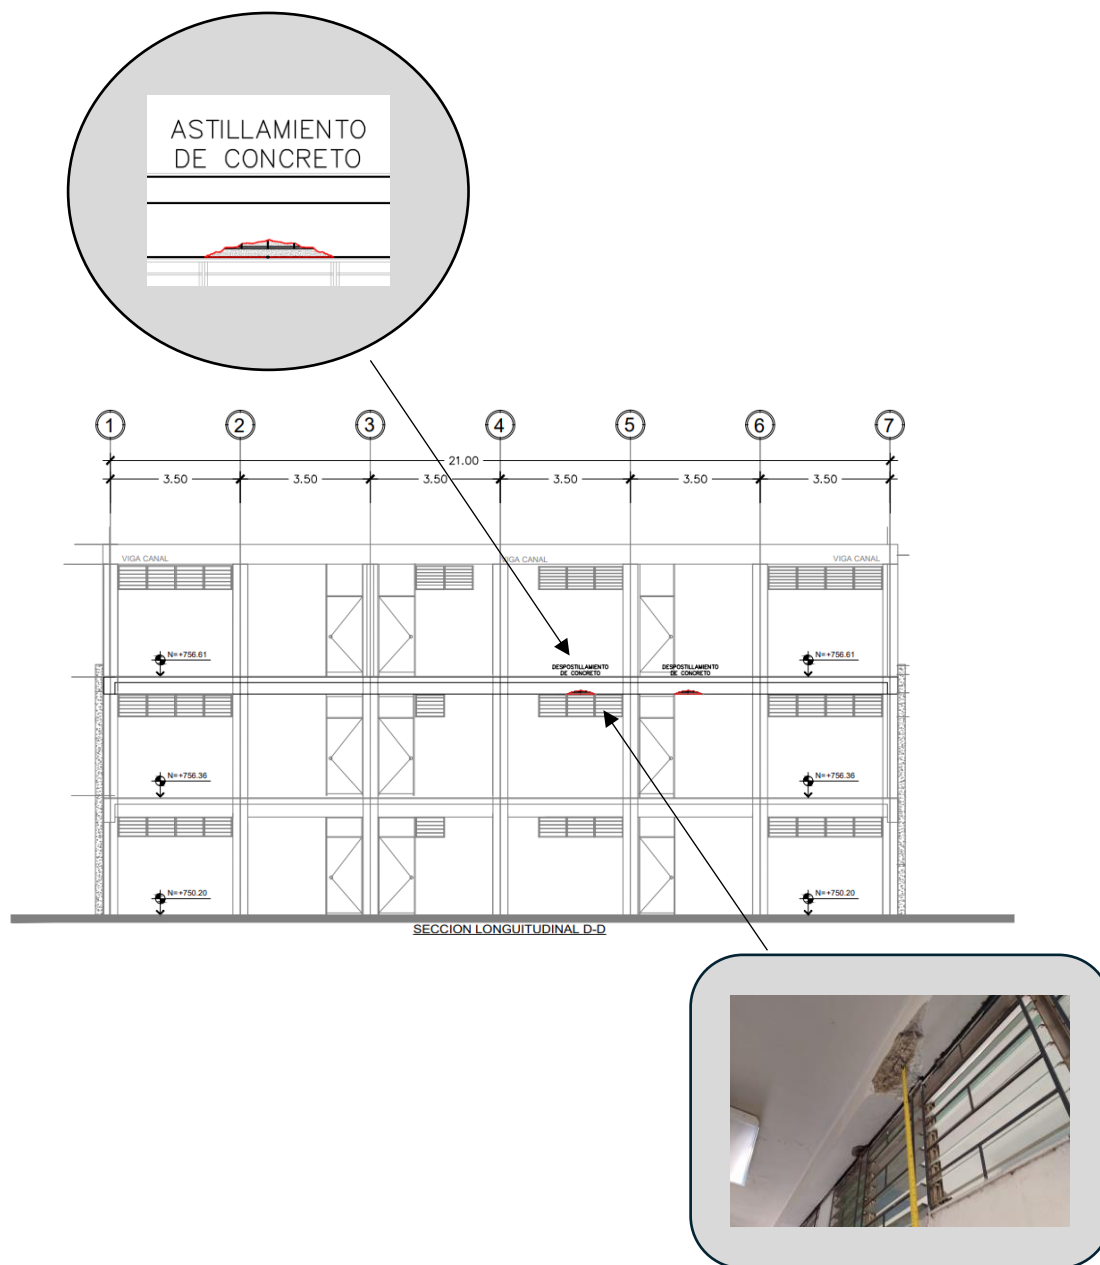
Esquema de daños en vigas perimetrales de escaleras, segundo nivel, paralelas a Módulo Sur.
